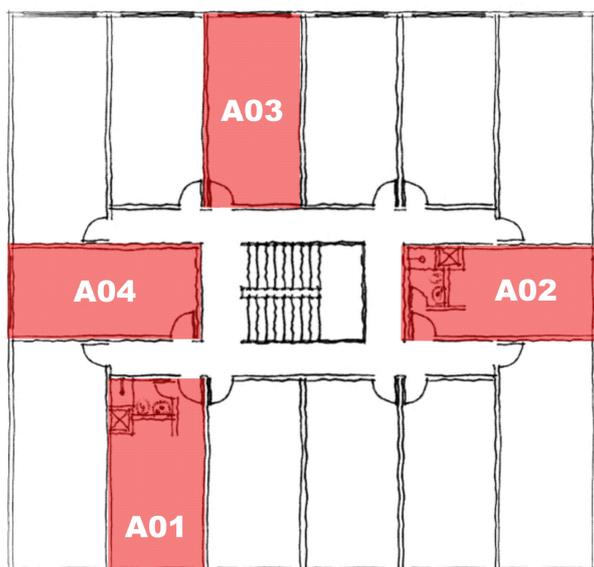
Planta de Situação da Amostra C (CLN 112 Bloco C)
